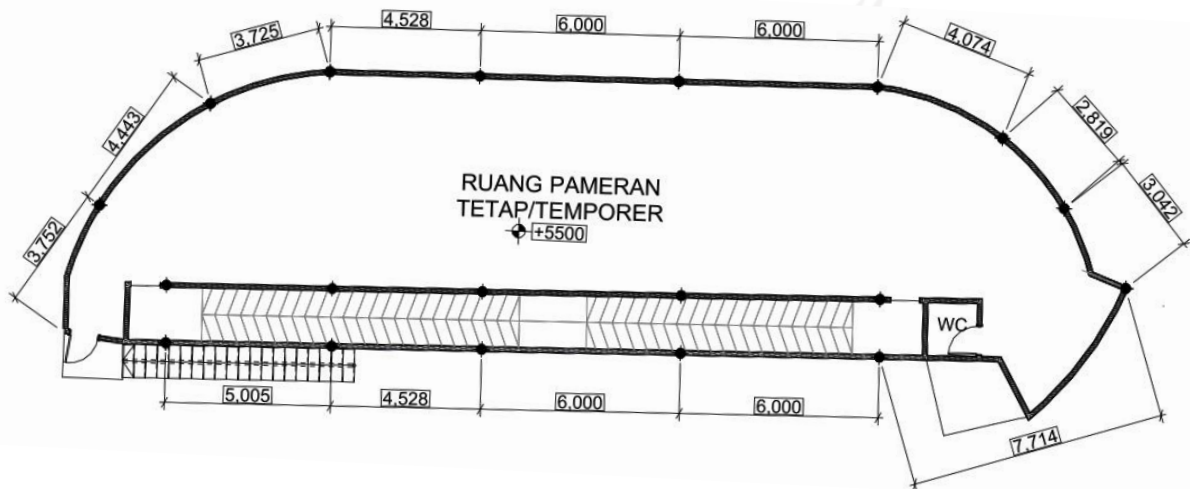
Denah Skematik Lantai 1 Gubahan 1
